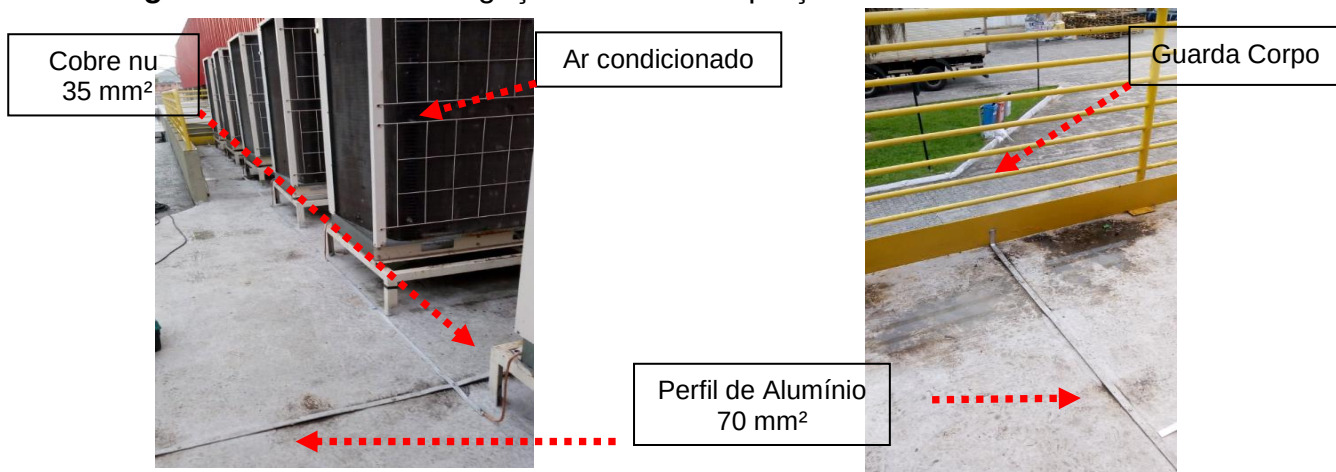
e 119: interligação malha de captação com estruturas metálicas.
